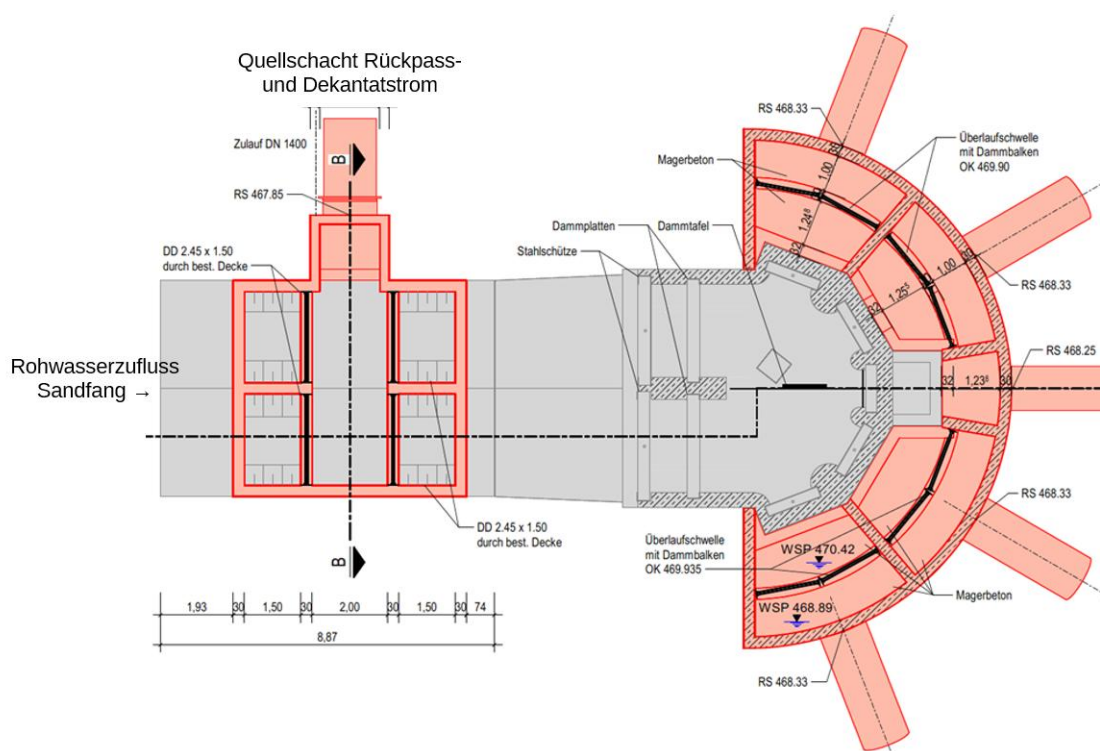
Draufsicht Verteilerschacht Vorklärung mit geplantem Quellschacht Rückpass
